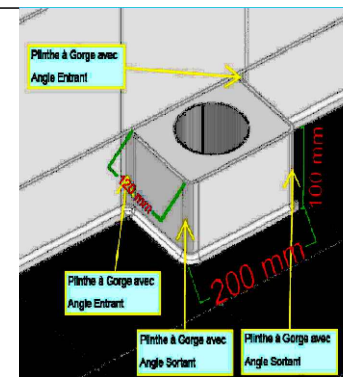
DETAIL EQUIPEMENT A DEVOIR EN LABO :
